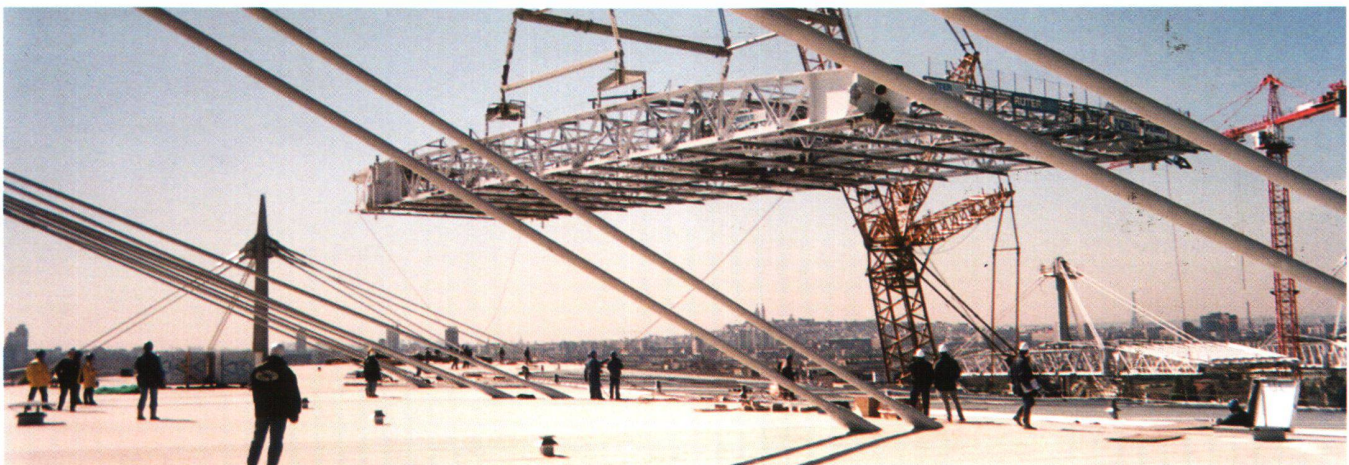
Die tragenden Elemente für die 61 000 Quadratmeter Dachfläche wurden vom Cabinet Cailleux-Fouché vermessen und eingewiesen.
